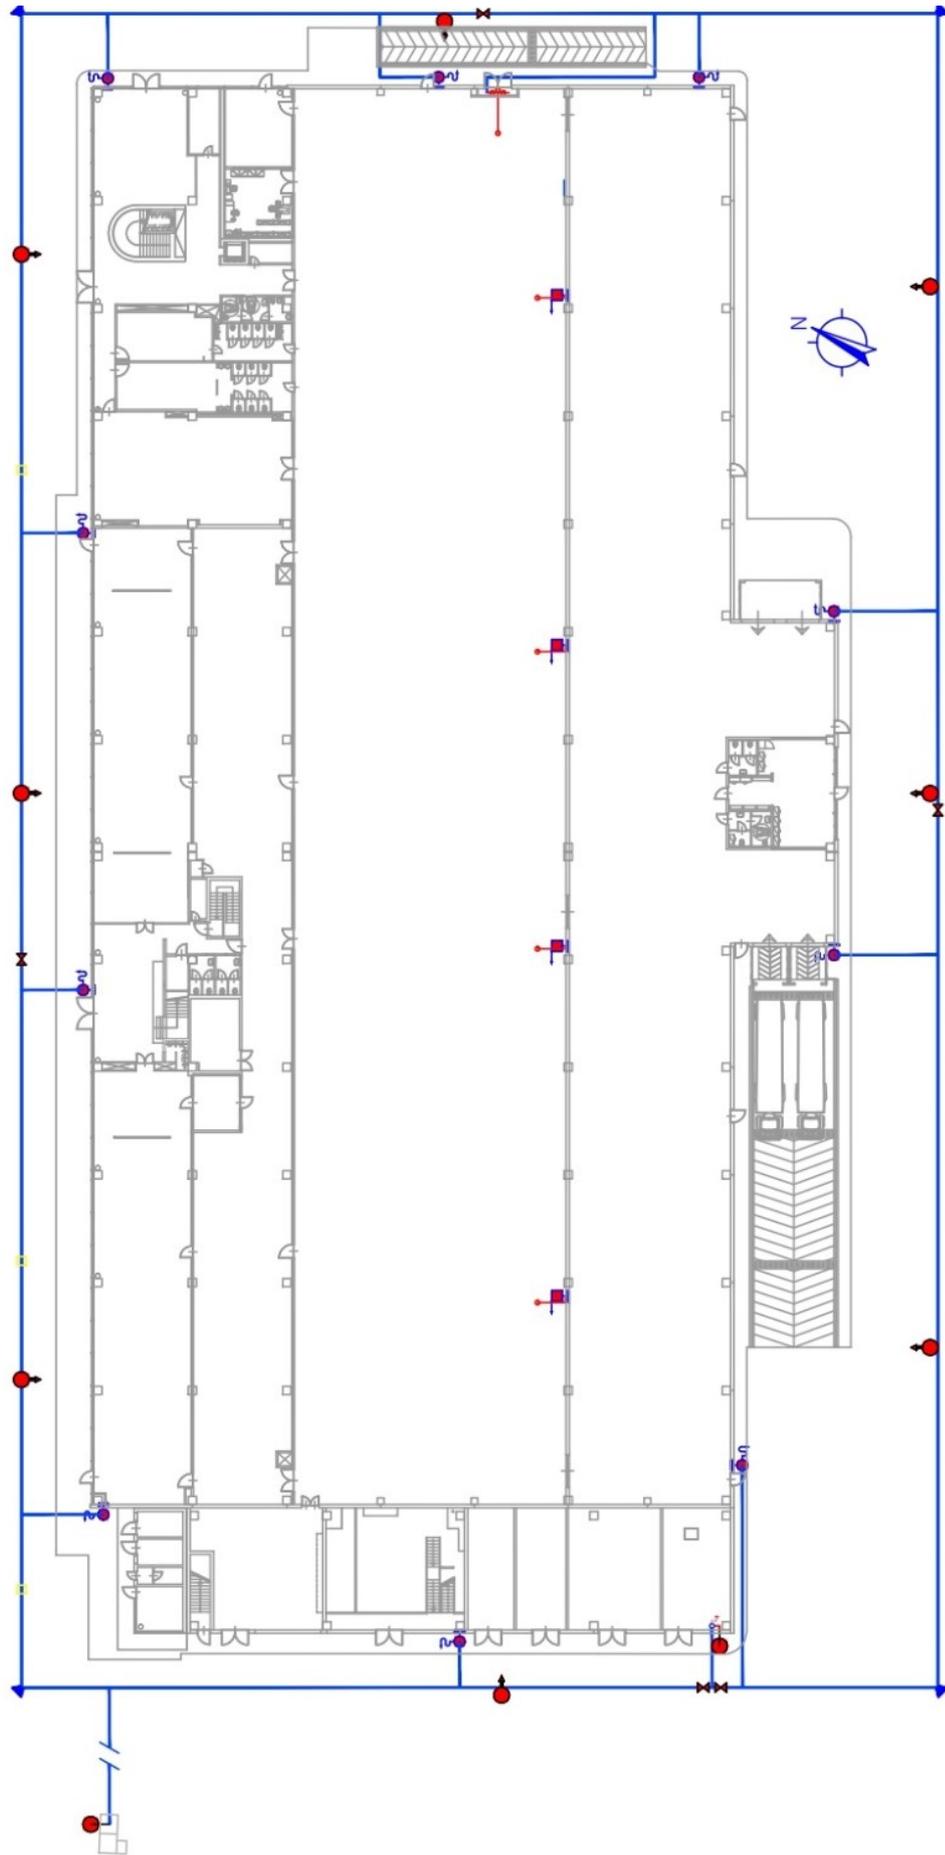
Planimetria completa idranti e nassi piano terra
